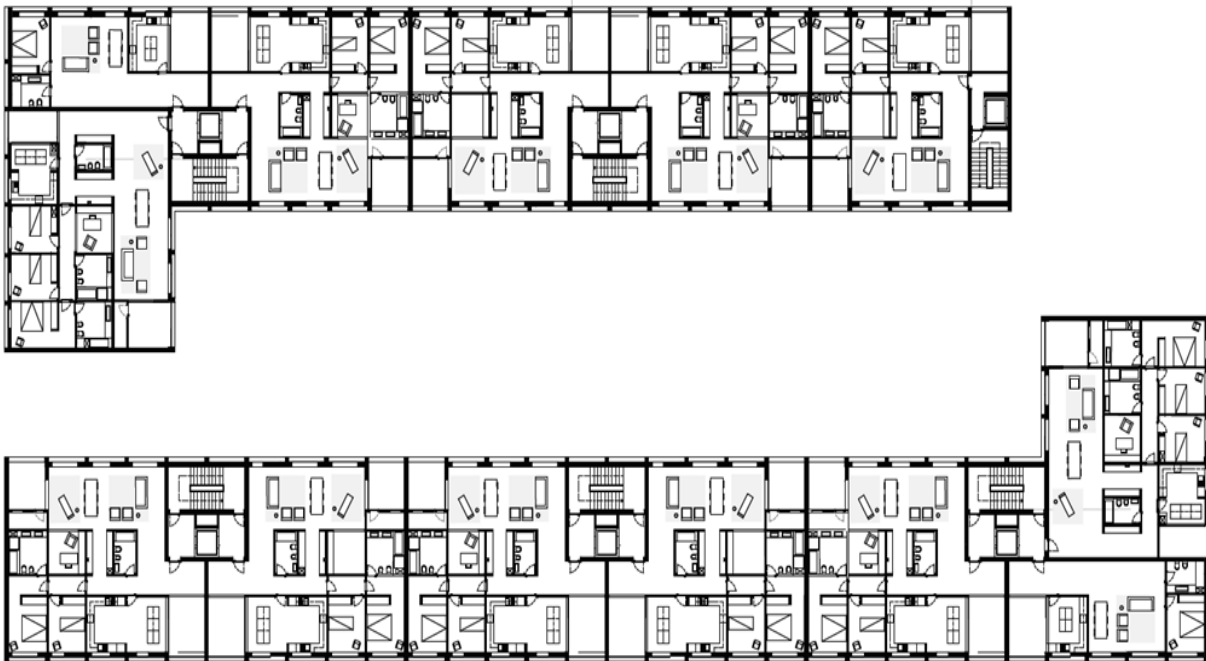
Planta dos apartamentos - planta dos pisos superiores
